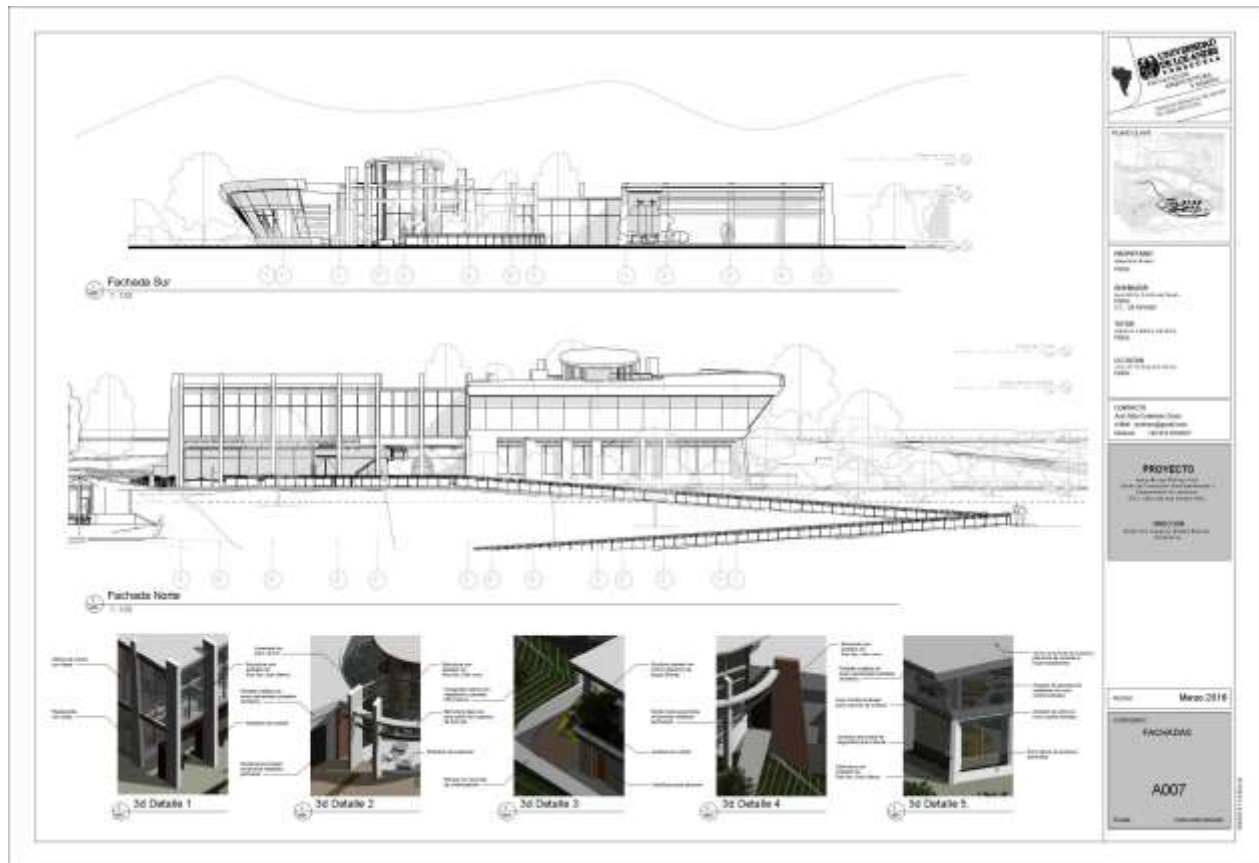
Fachadas Norte, Sur y detalles exteriores.
